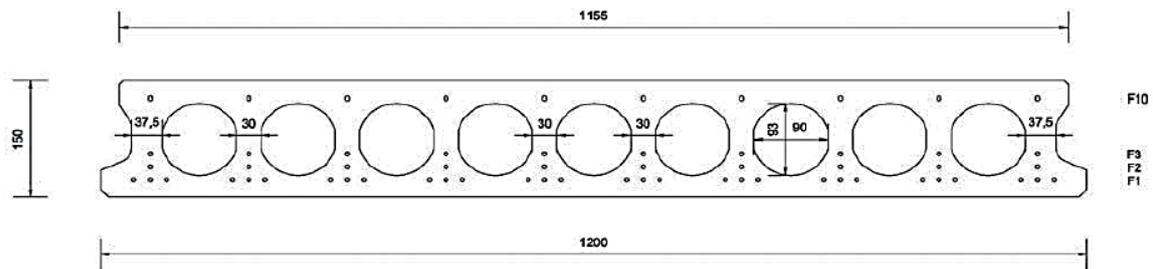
Sección acotada (mm) de la placa alveolar P15x120 del fabricante ALJEMA PREFABRICADOS.
